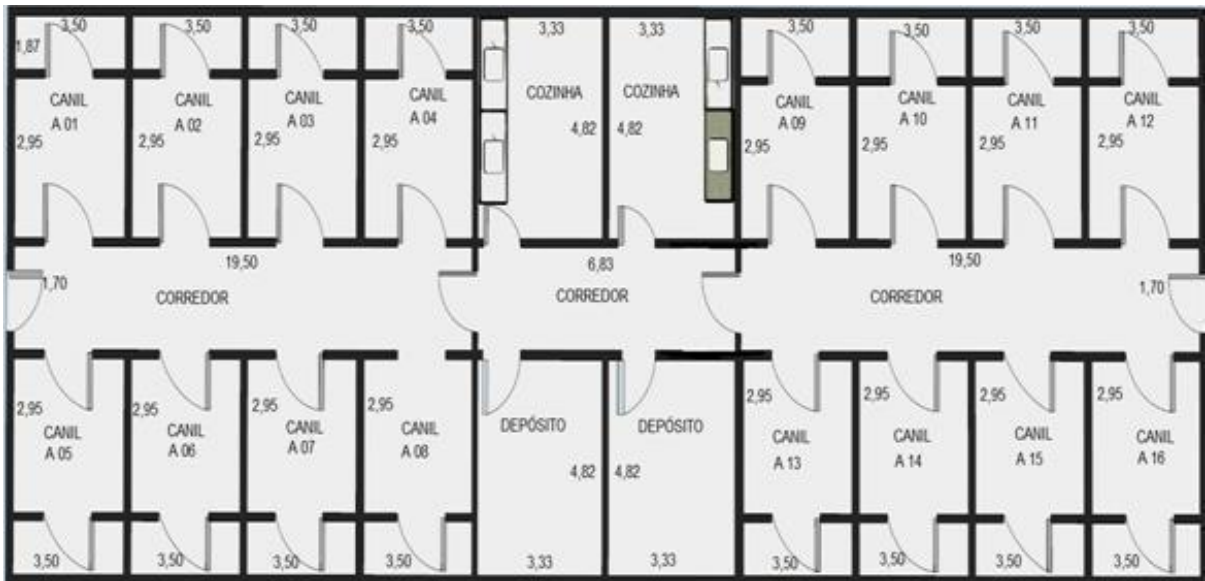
Vista da planta baixa da área de canis da FMVZ
